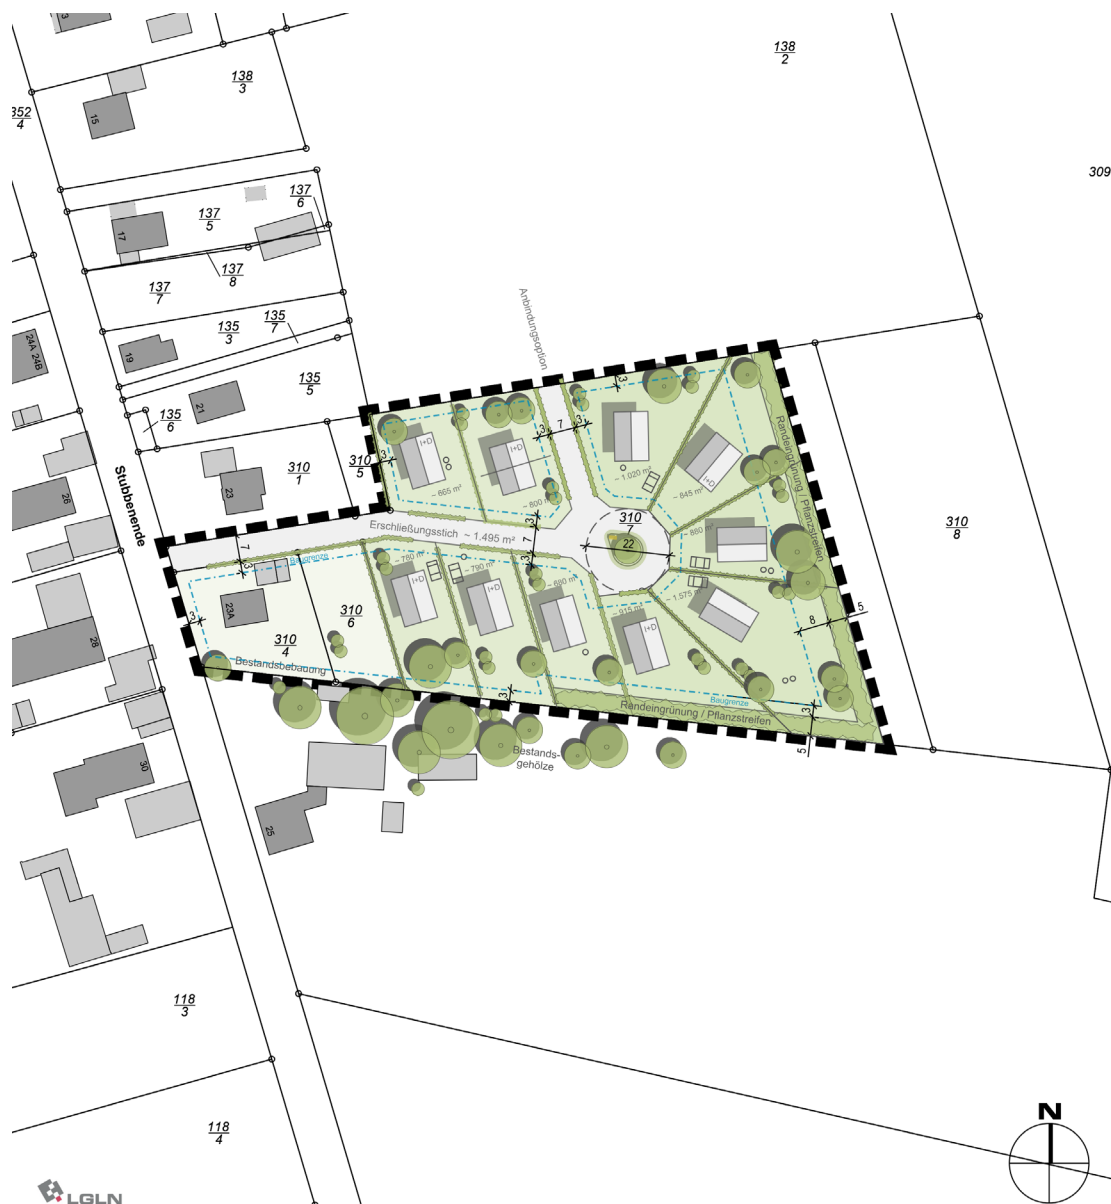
Städtebauliches Konzept Stand Dez. 2025 (o. M.) – Cappel + Kranzhoff, Stadtentwicklung und Planung GmbH
